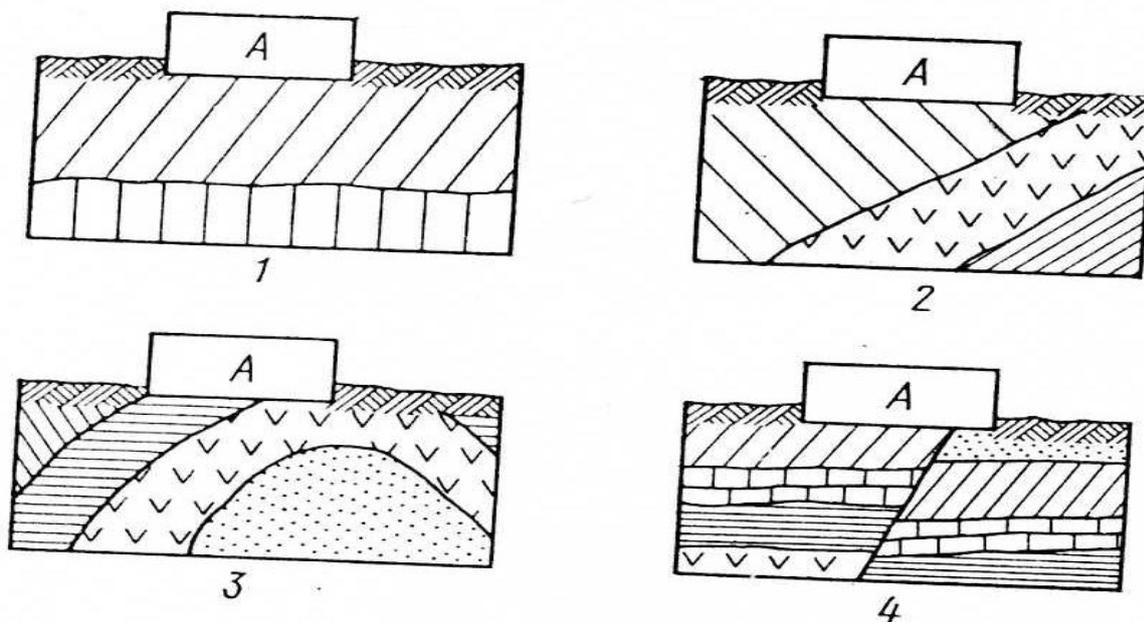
Возможные варианты геологического строения строительных площадок: 1,2 – благоприятные площадки для строительства; 3 – малоблагоприятные площадки для строительства; 4 – неблагоприятные площадки для строительства. А – здание [1, 12]
